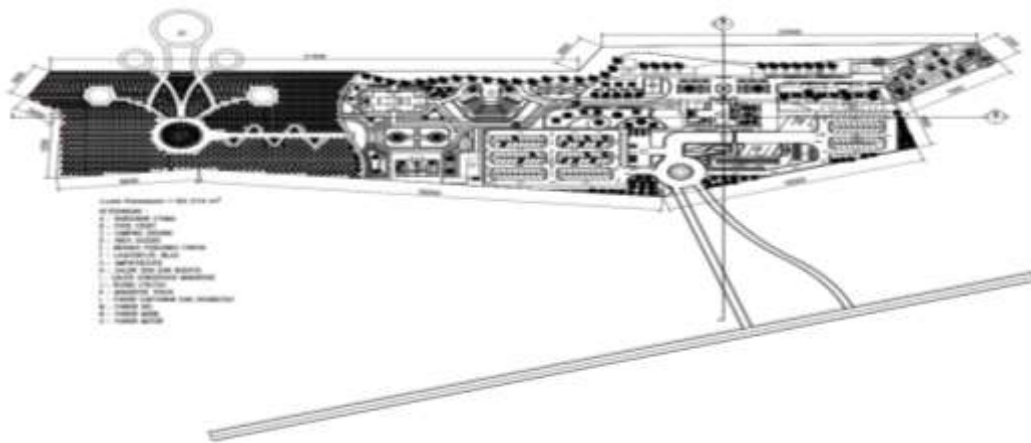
Unsur Pendekatan Desain Pada Bangunan
